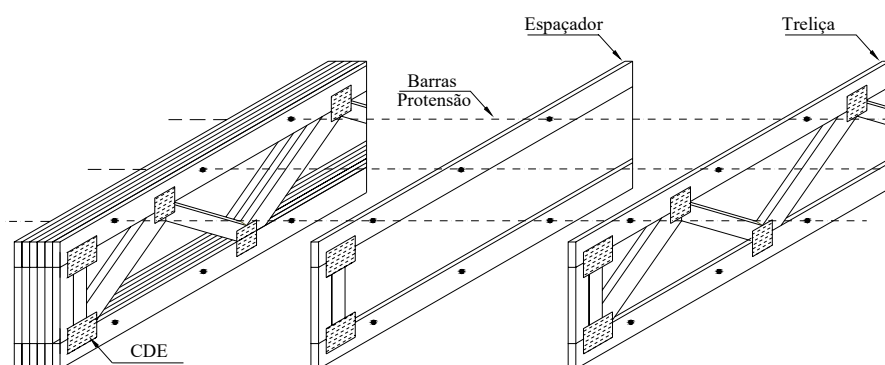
Arranjo do tabuleiro treliçado protendido transversalmente.
